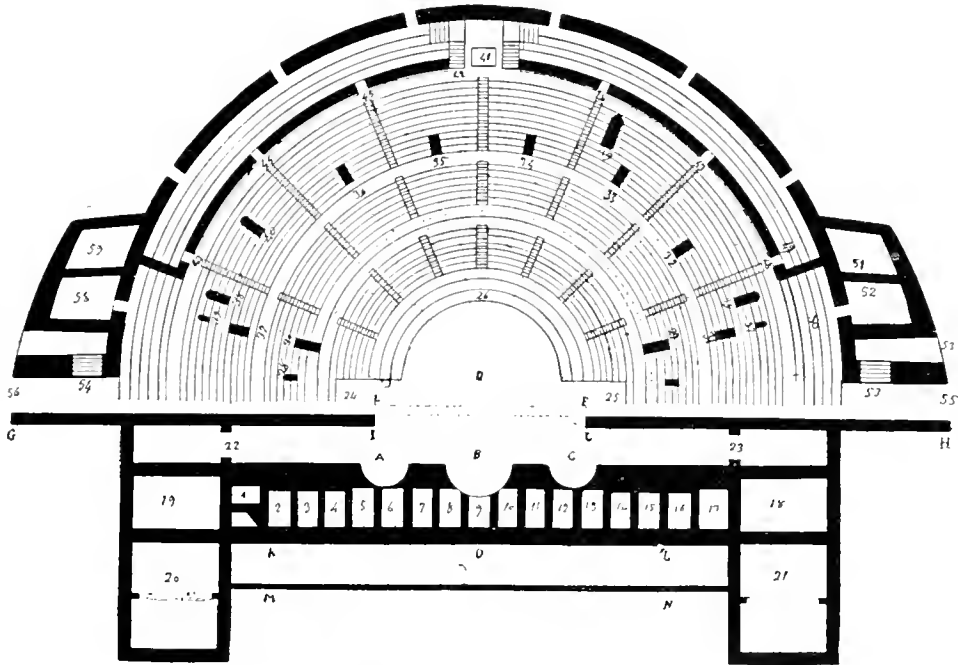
Teatre de Sagunte. Plan segons Chabret
